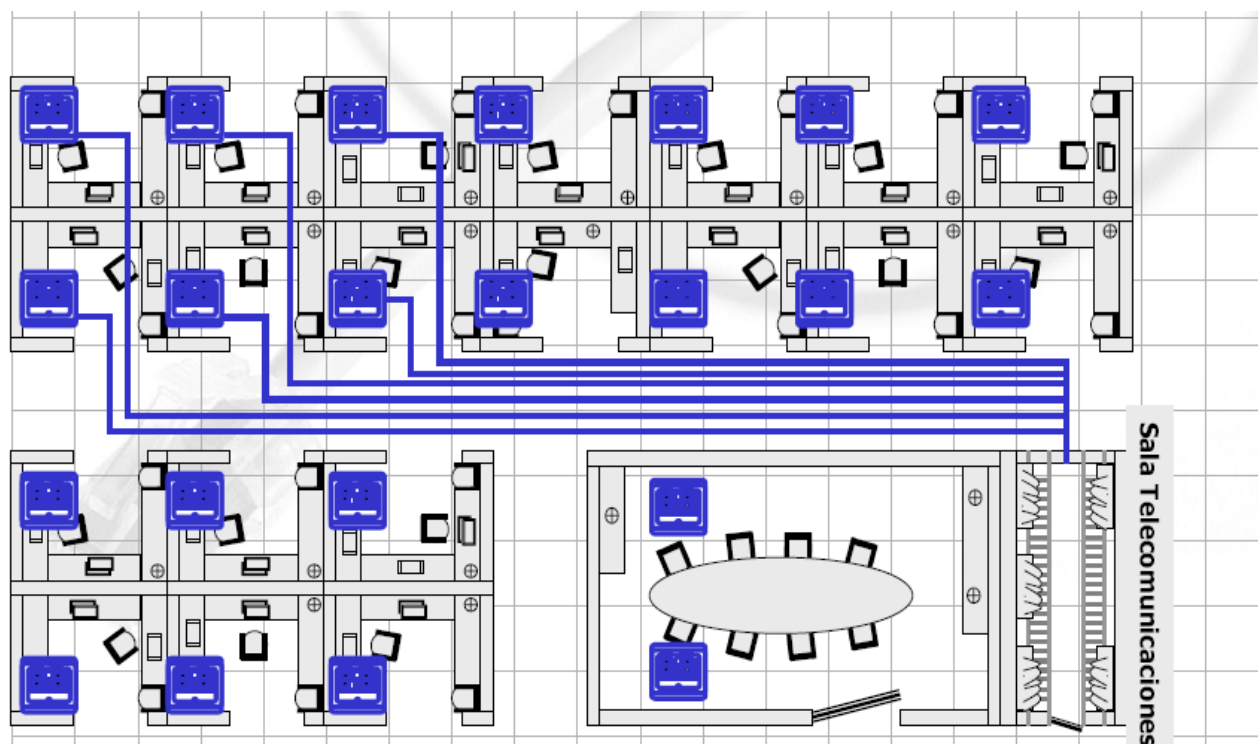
Subsistema horizontal con cableado directo a las TTs
